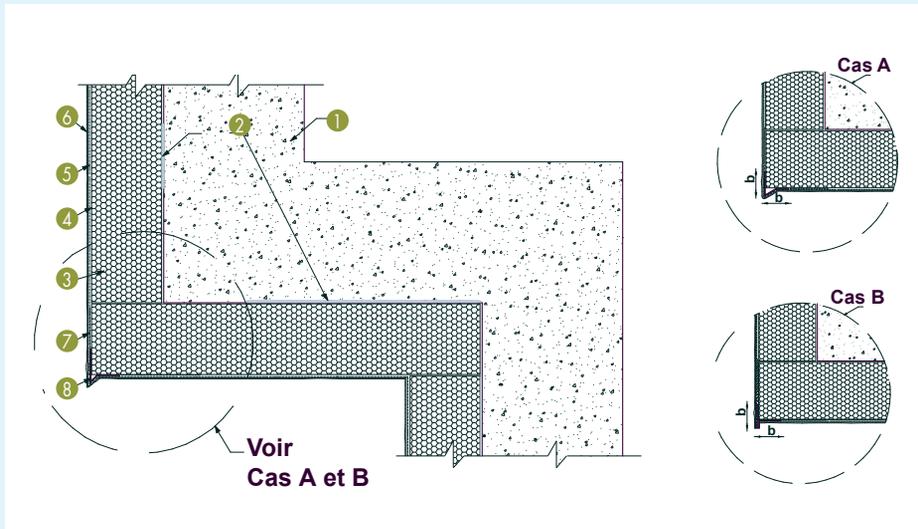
Angles horizontaux - Cas A et B (coupe verticale)
